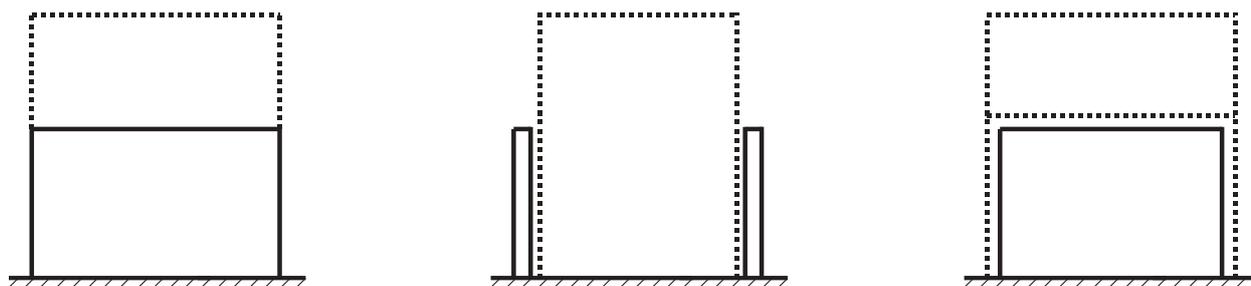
Схемы: 1 – надстройки при опирании на существующие элементы здания; 2 – тоже, с внутренним каркасом; 3 – возведение над существующей формой независимого внешнего каркаса
